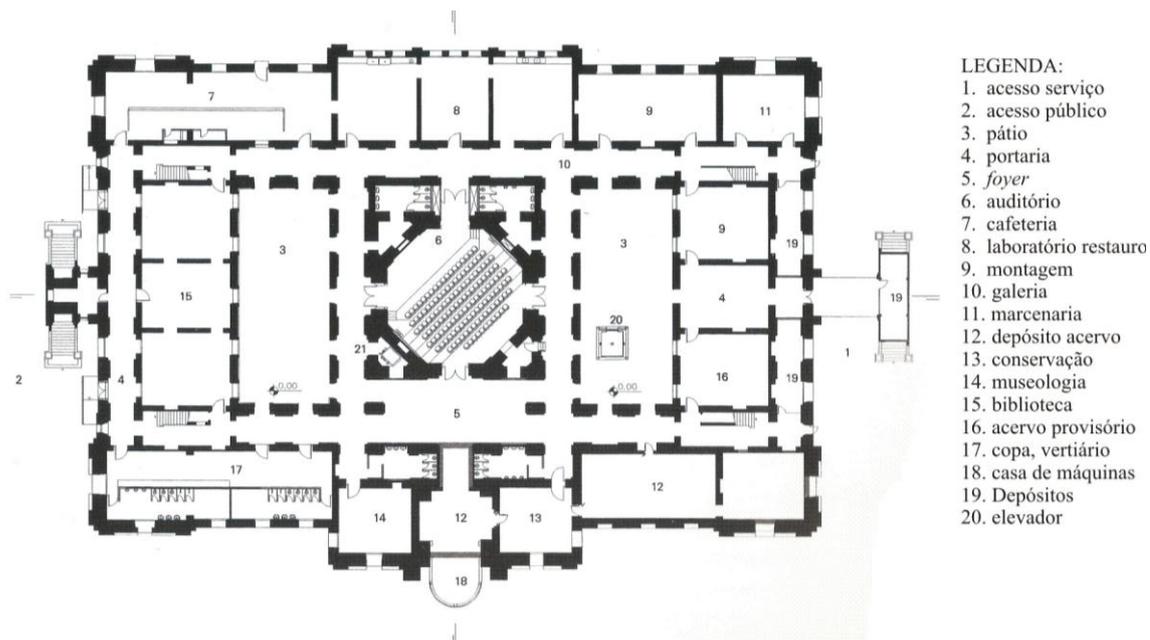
Planta do pavimento térreo da Pinacoteca do Estado de São Paulo.
